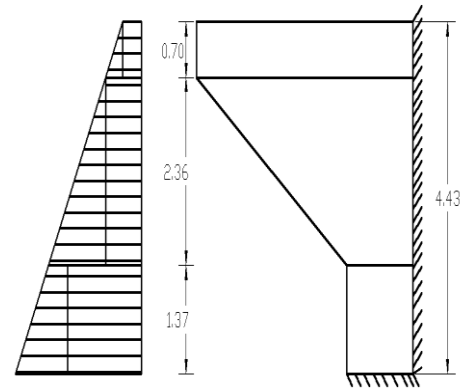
poussées de terres et surcharge sur le mur en retour
